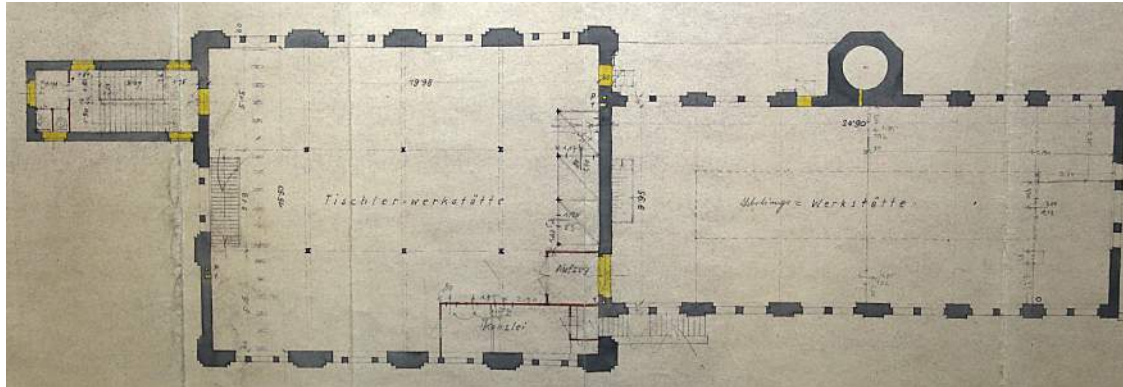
Im Obergeschoß befindliche Tischler sowie Lehrlingswerkstätte; Planmappe 1938
